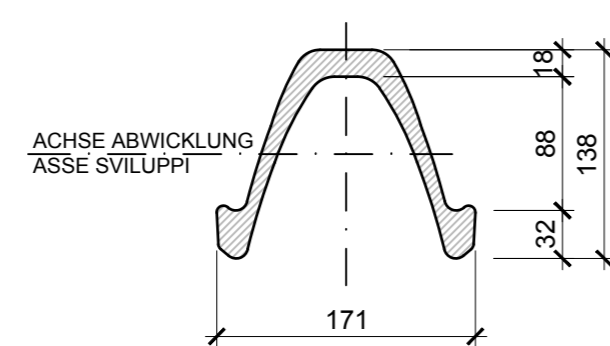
DETAIL VERBINDUNG DER STAHLBÖGEN PARTICOLARE SERRAGGIO CENTINE
